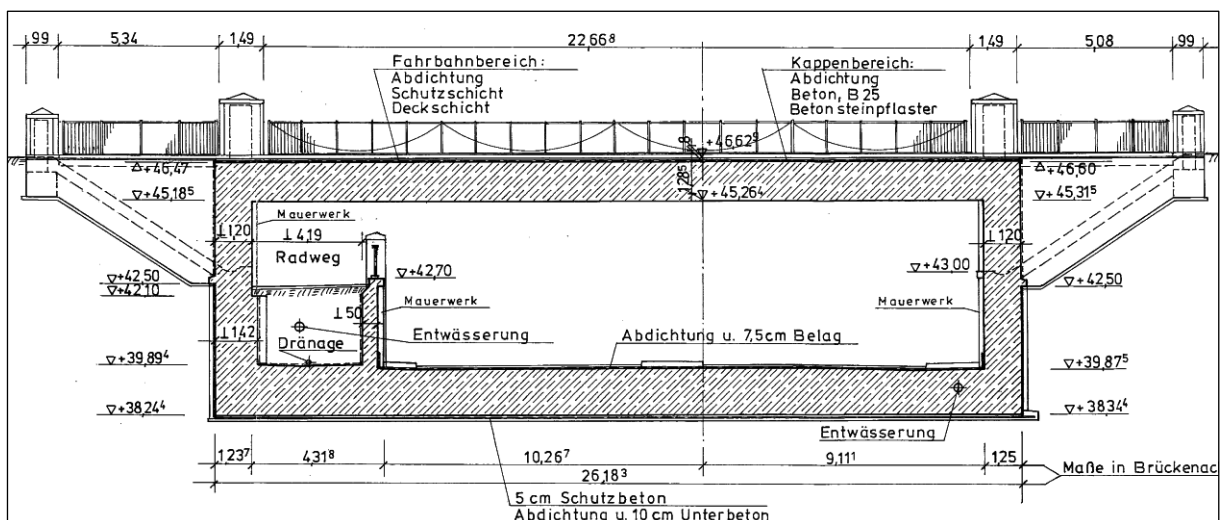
Schnitt F-F (Brücke Bismarck Allee) – Segment 11
